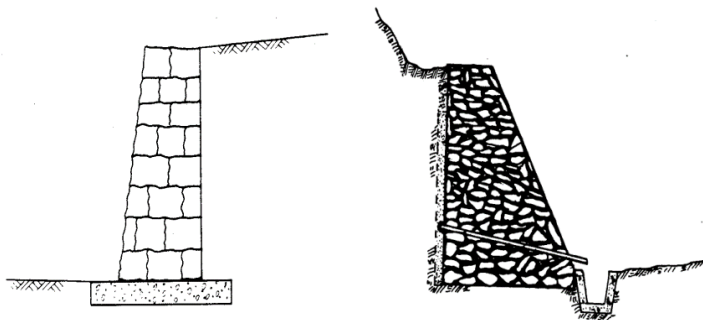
Pormenor esquemático de muros de gravidade em alvenaria de pedra (Fac. Eng, 2017)
